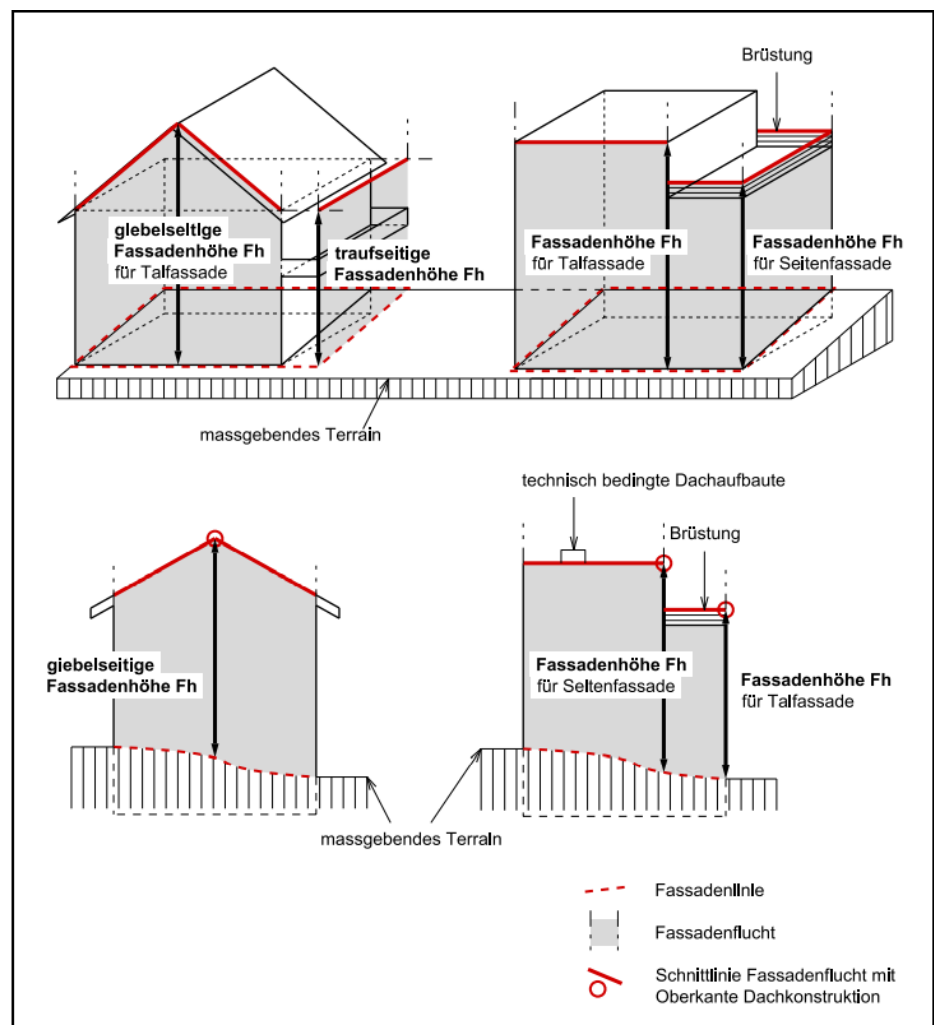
Schema Fassadenhöhe gemäss § 278 PBG
